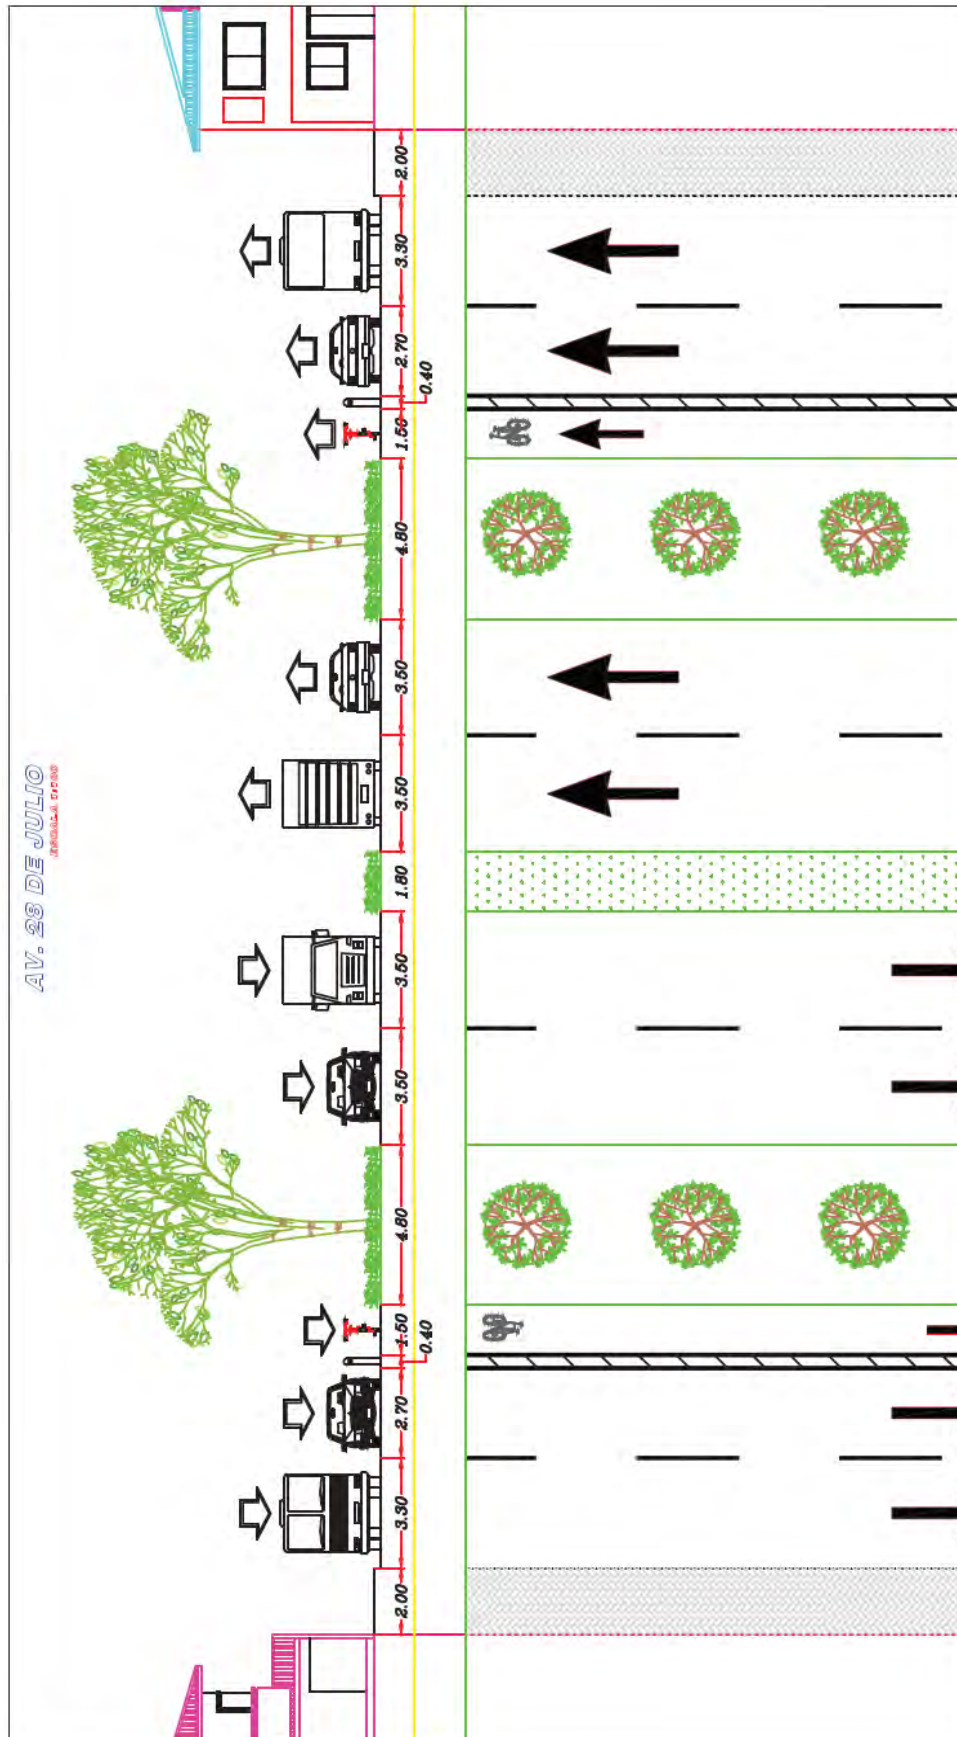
Propuesta Sección Transversal Av. 20 de Julio.
